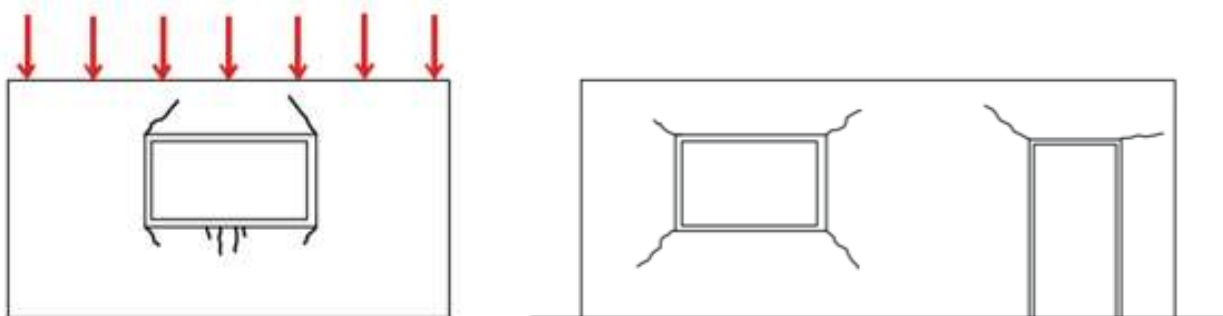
Configuração típica de fissuras causadas por sobrecargas em torno de aberturas
